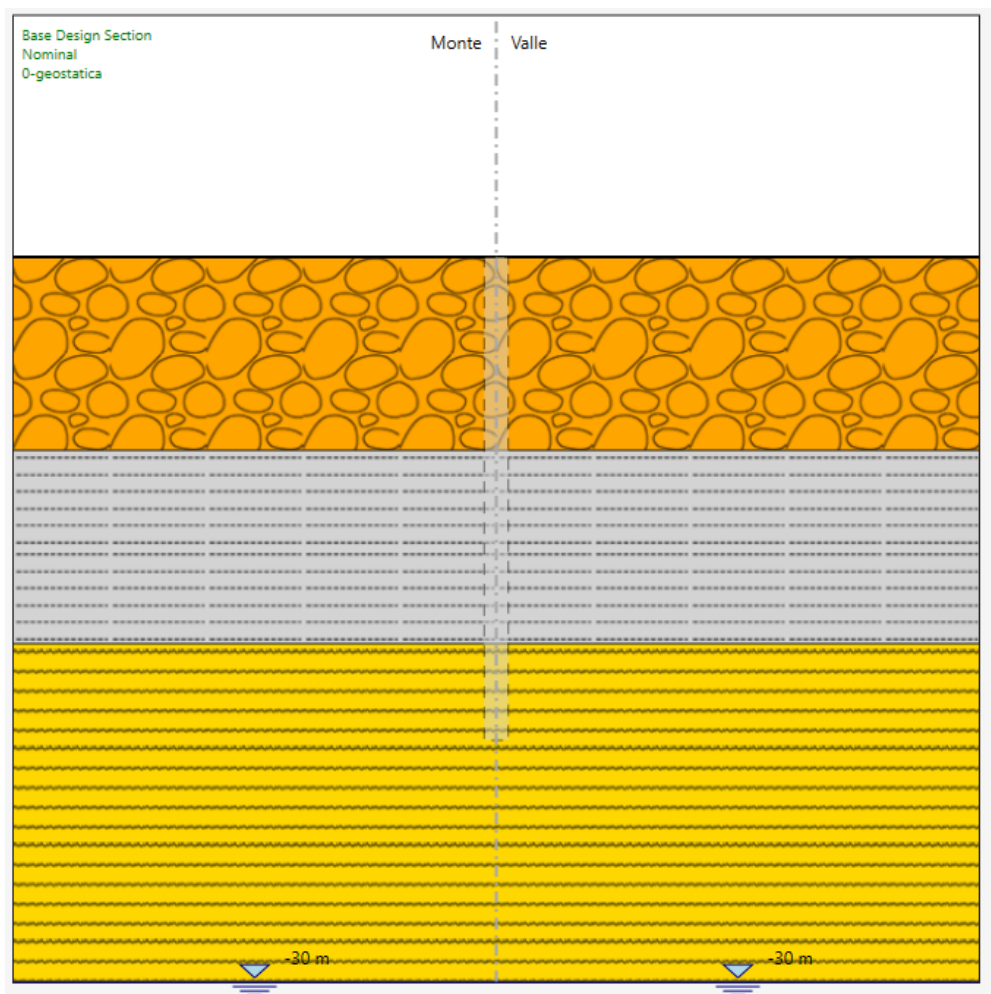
Stralcio del profilo geotecnico in corrispondenza della spalla B.
